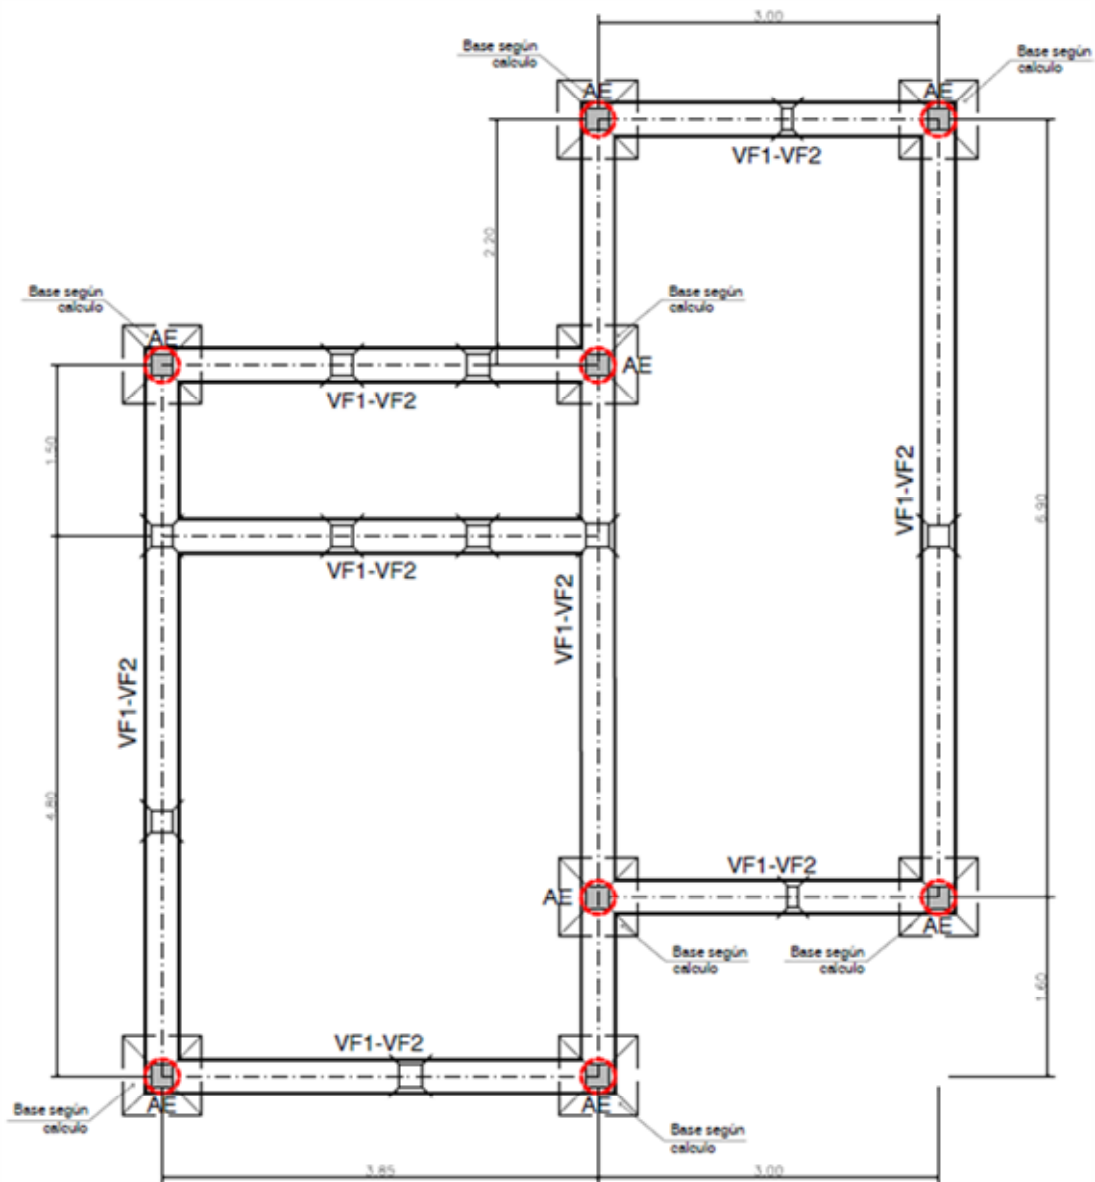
Planta fundación de la vivienda aislada de una planta.
